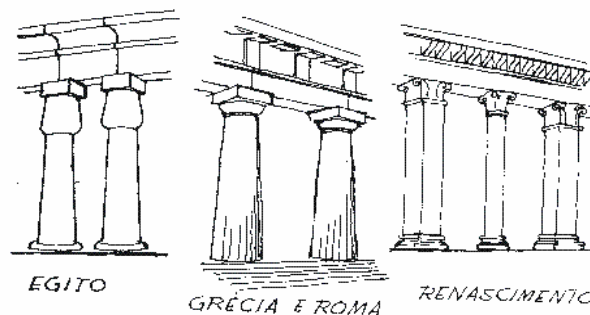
Exemplos do uso do sistema trilitico. Fonte: BOLTSHAUSER (1963)
